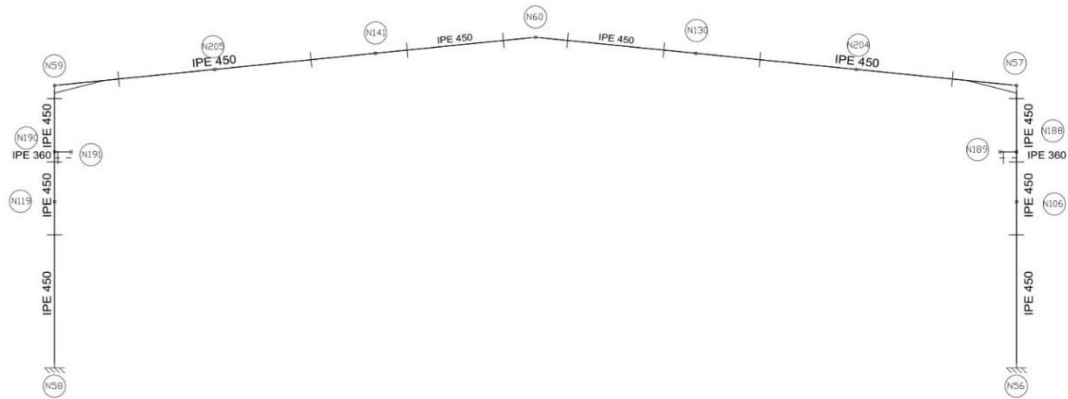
Perfiles del pórtico interior. Fuente: Elaboración propia a partir de CYPE 3D
